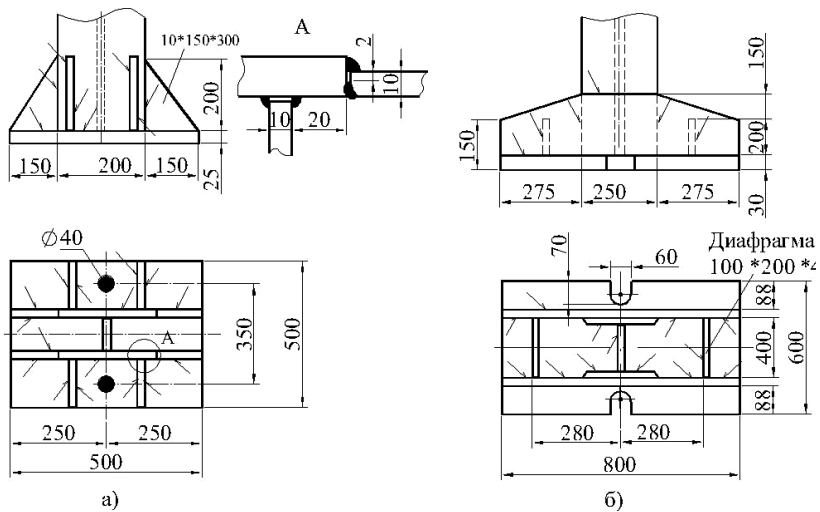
Сварная база: *а* – с треугольными ребрами;
